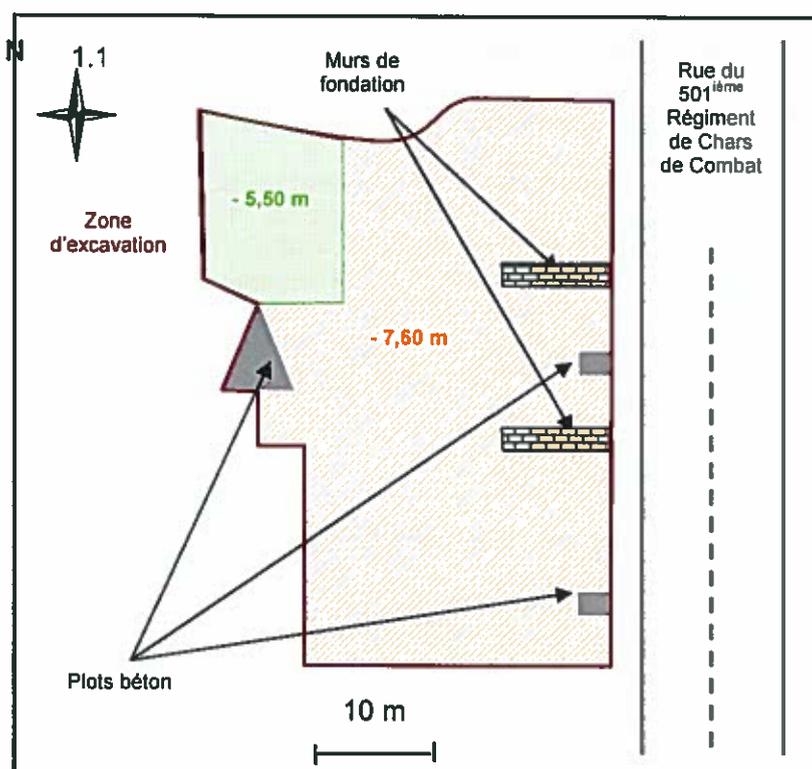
Plan schématique de l'emprise de la fouille d'excavation
